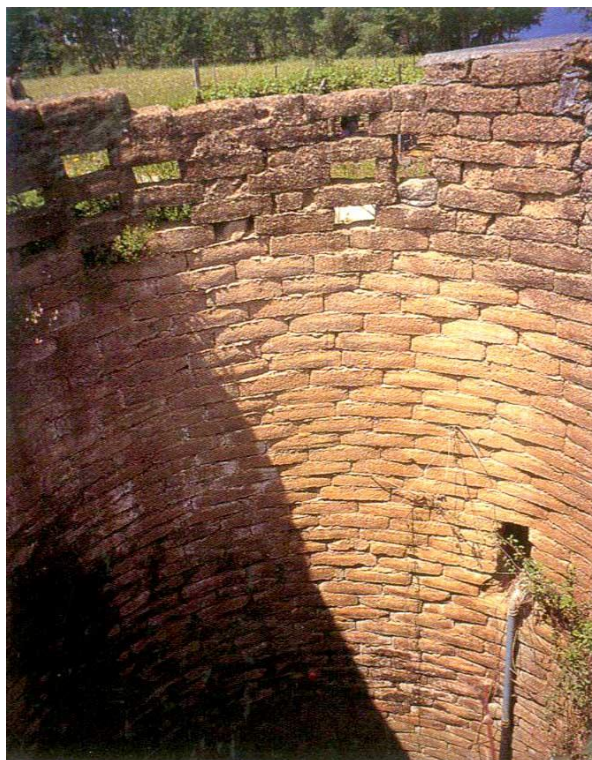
Poço em Aveiro em alvenaria de adobe.
